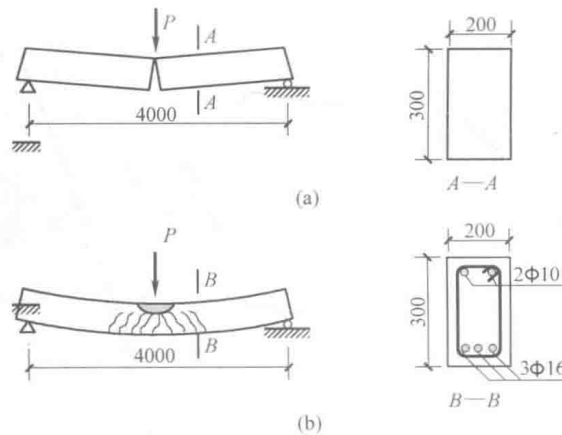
素混凝土梁和钢筋混凝土梁荷载试验
